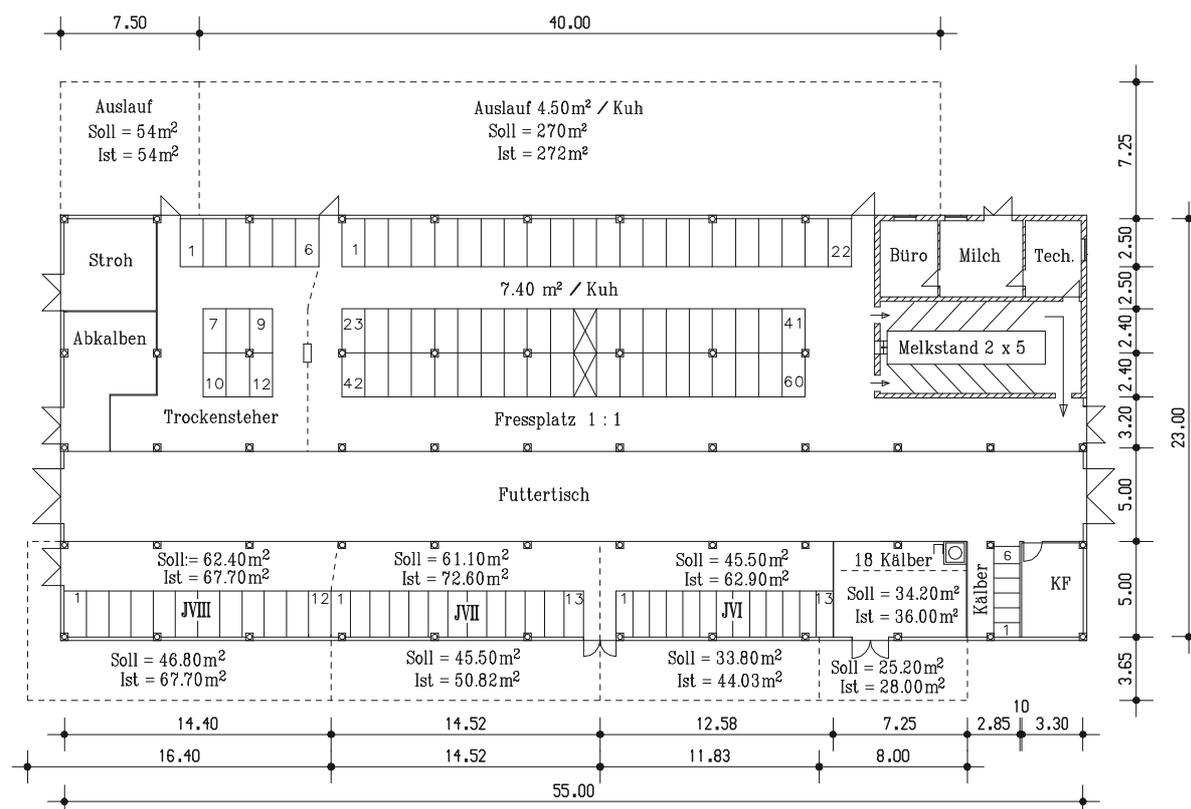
Geschlossener dreireihiger Liegeboxenlaufstall mit Nachzucht, jedoch mit erforderlichen Außenflächen für Kühe, Kälber und Jungvieh (ÖKO)
